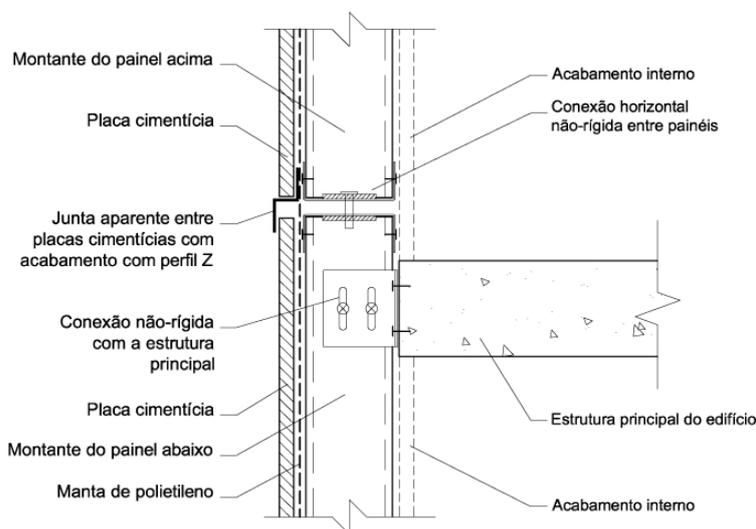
Painel contínuo com junta em perfil Z em placa cimentícia sobre conexão não-rígida
